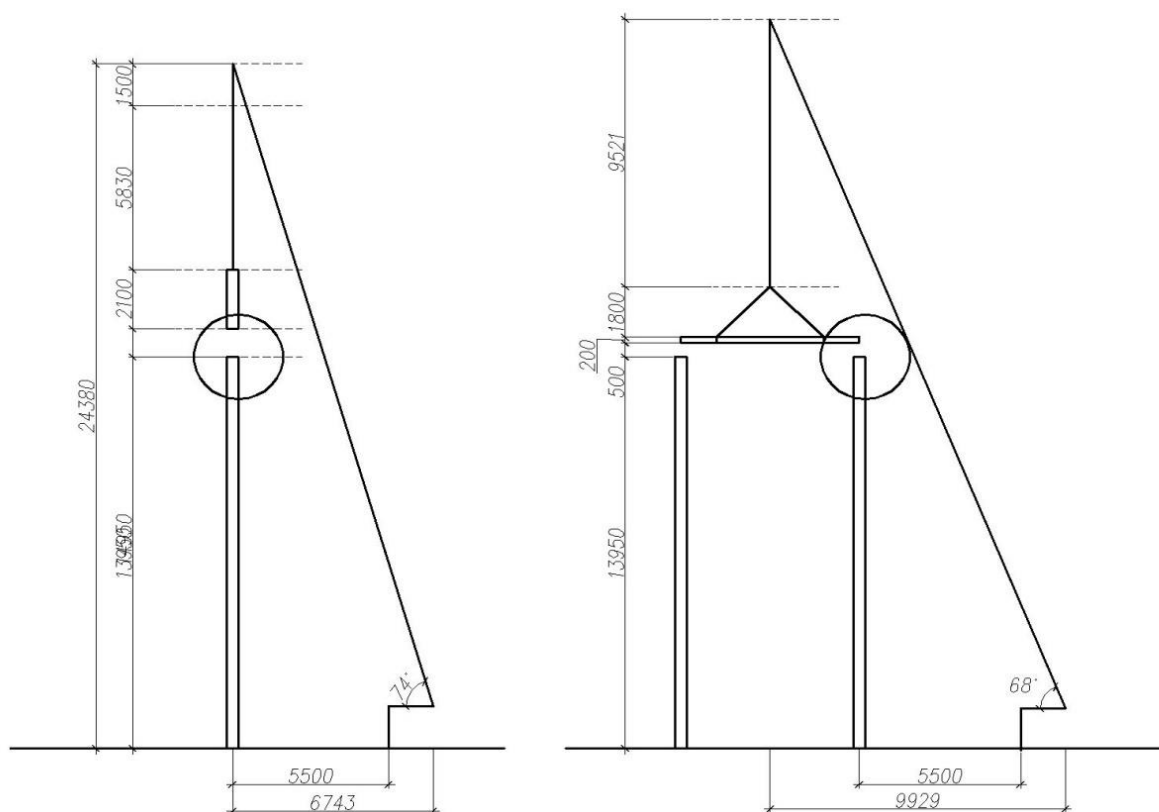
Выбор крана для монтажа ферм и прогонов.
